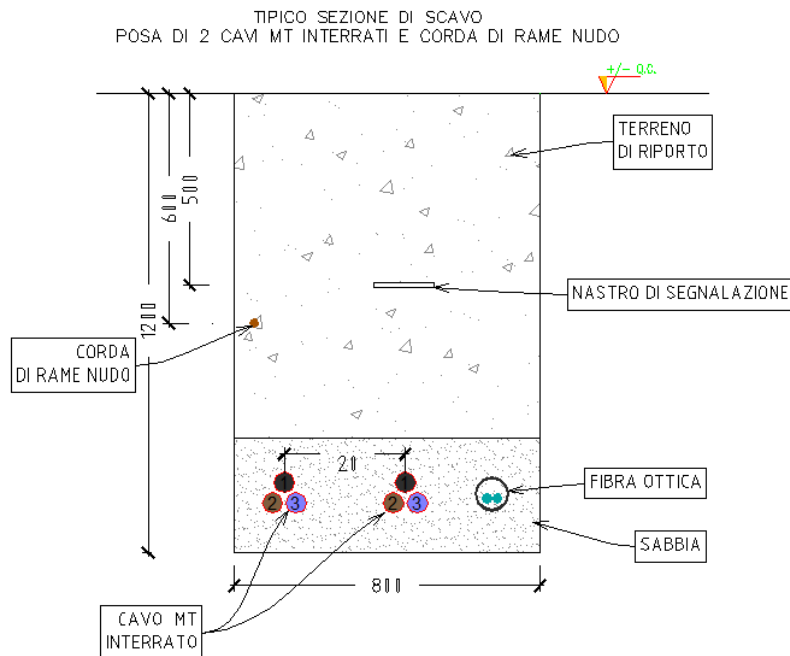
Sezione tipo posa cavo MT con n° 2 linee
